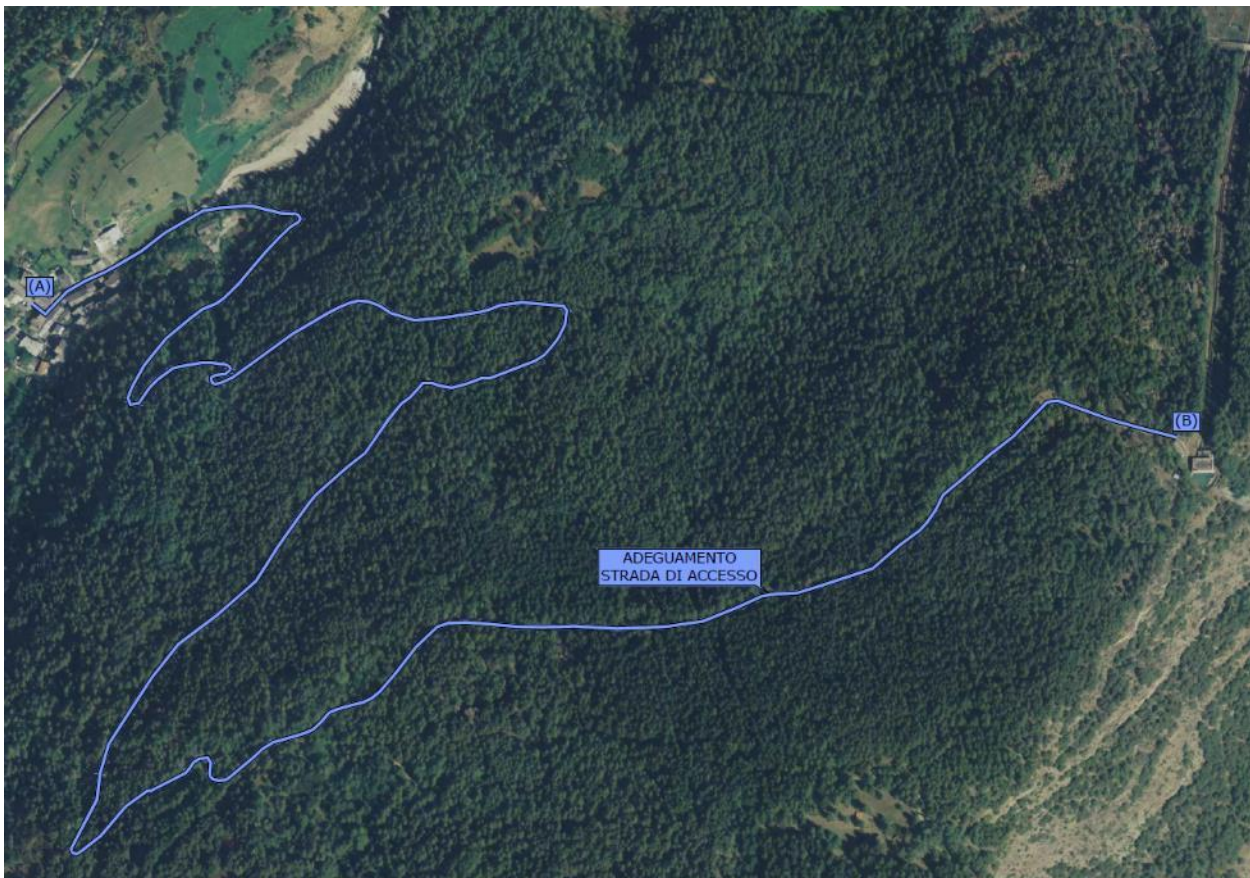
Lotto II A cantiere C Adeguamento strada di accesso Poignon
